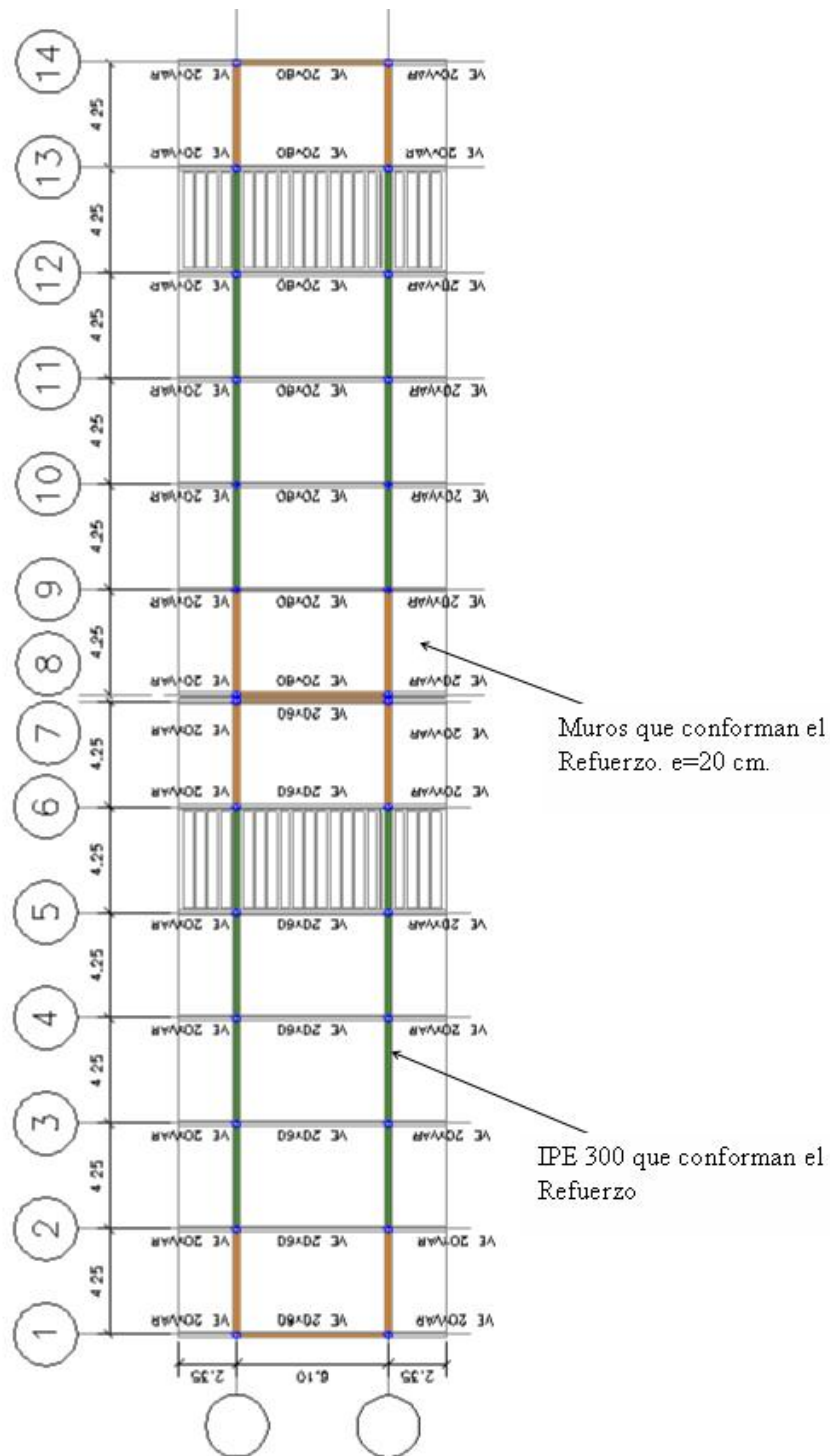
Planta Nivel +2.90 y +5.80
